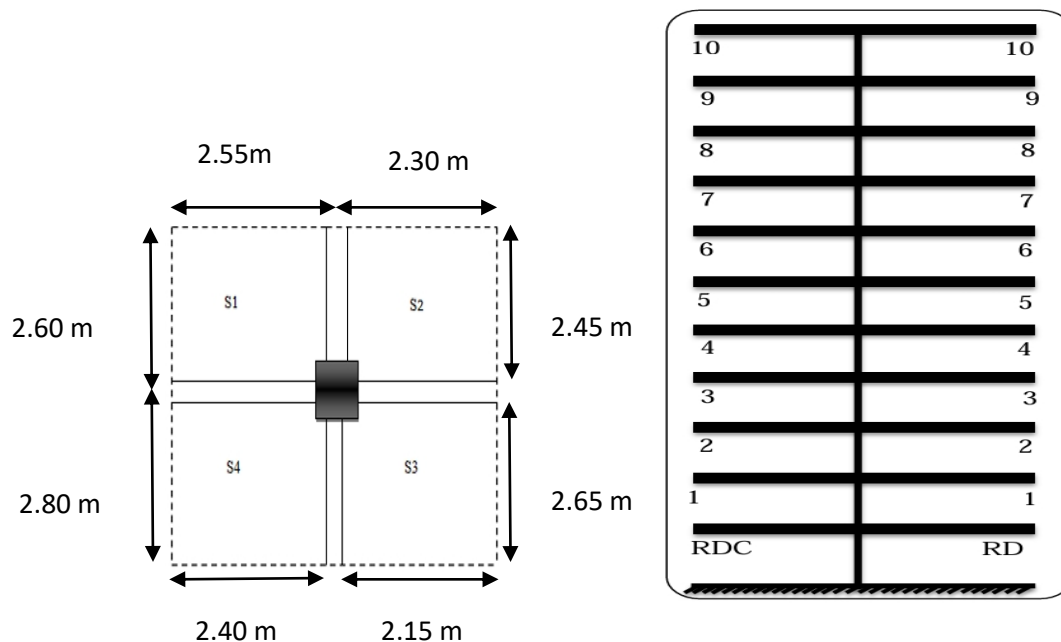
La surface attérente du poteau E-4. Figure II. 15 : Coupe vertical des poteaux E-4.
